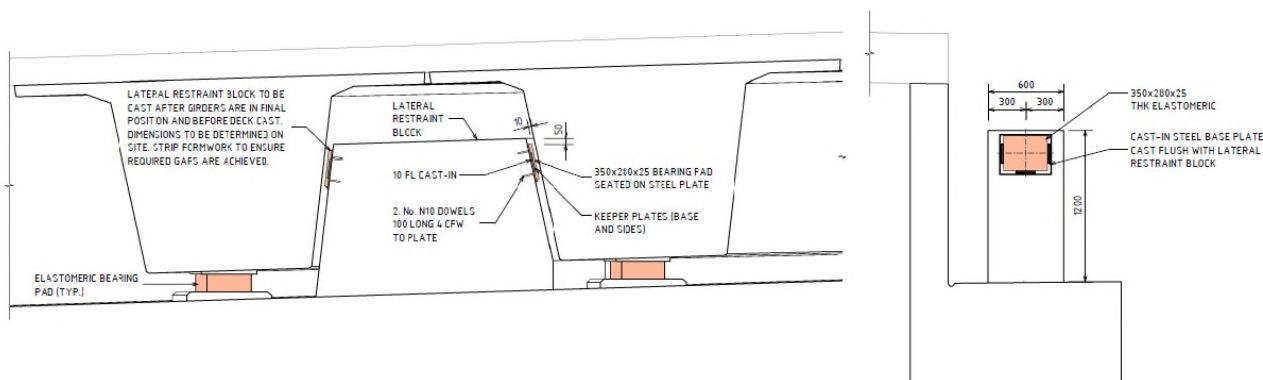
Detalle de topes sísmicos entre vigas Super-T en los estribos.
